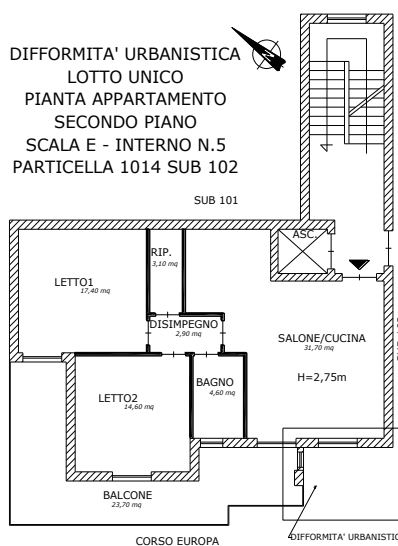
planimetria delle difformità urbanistiche dell’appartamento pignorato al secondo piano
